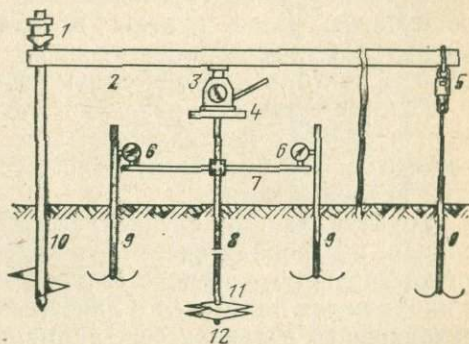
Схема установки КРУ-600 для испытаний опытными нагрузками в скважине.
